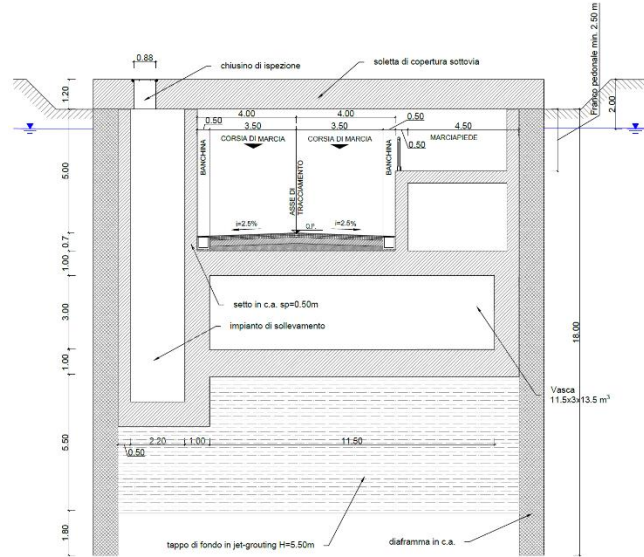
SL01 – Sezione trasversale da pk. 0+168.5 a pk. 0+182.00.
